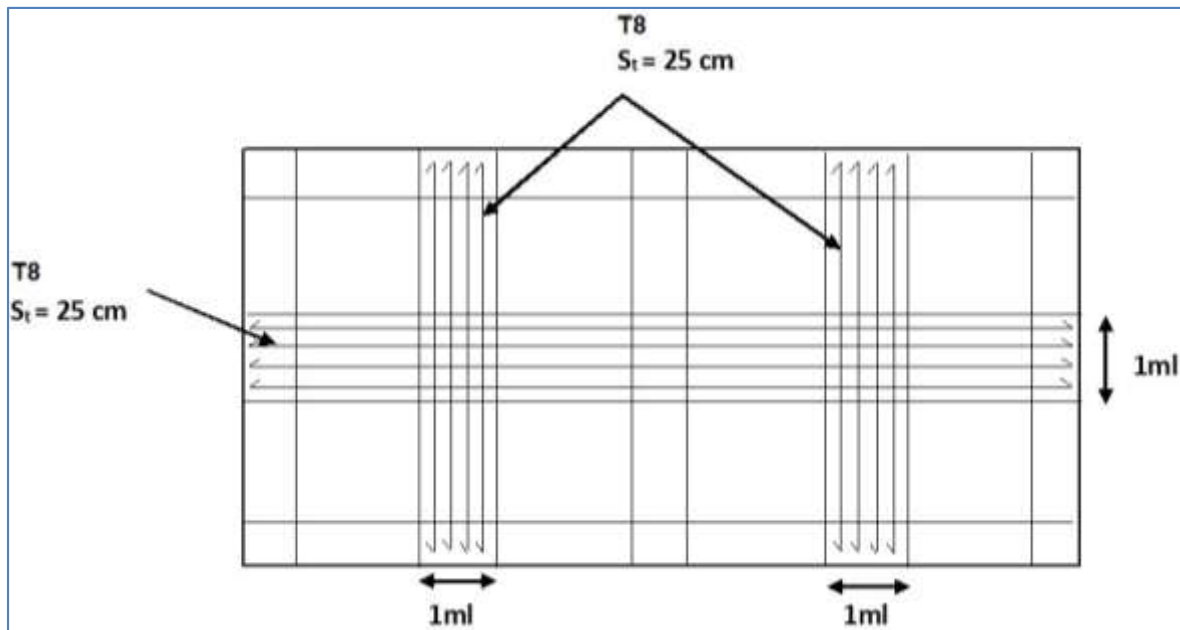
Nappe inférieure du ferrailage de la rampe d'accès.
